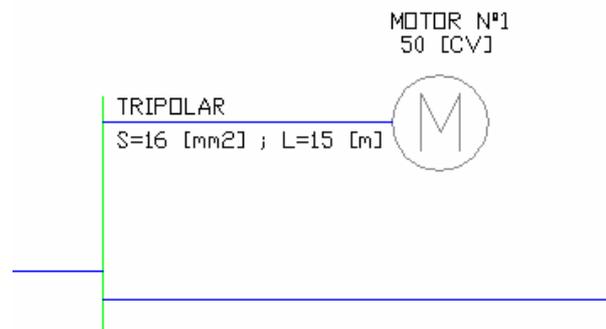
Datos del Cable del Motor sobre la pantalla de AutoCAD
